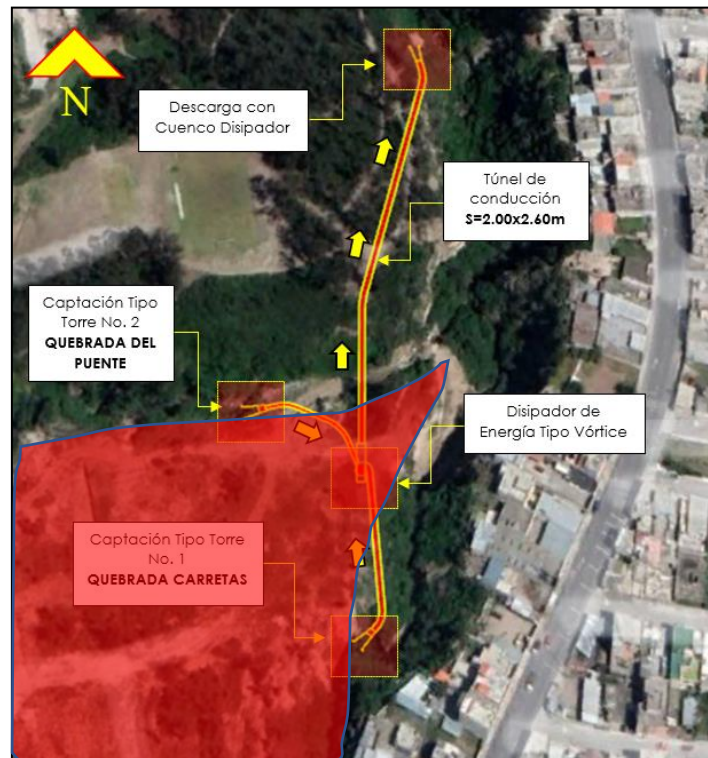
Estructuras hidráulicas Quebrada Carretas
